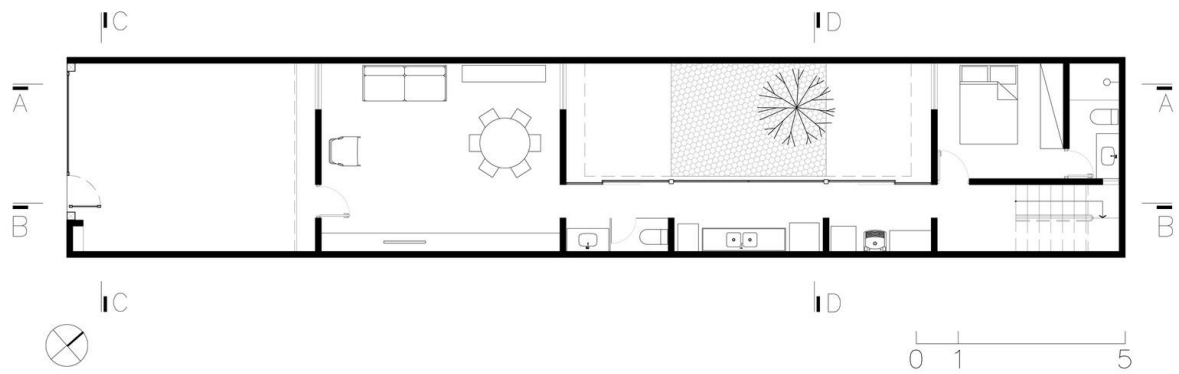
Planta do pavimento térreo - Casa Vila Matilde
